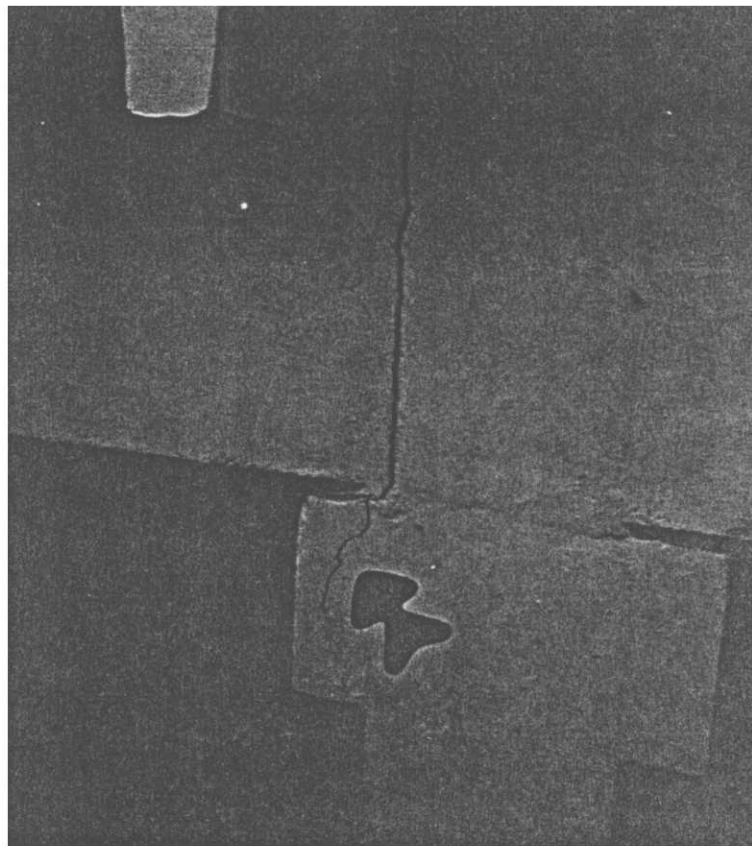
Detalle de la separación entre vigas y agrietamiento diagonal en la mensula.
